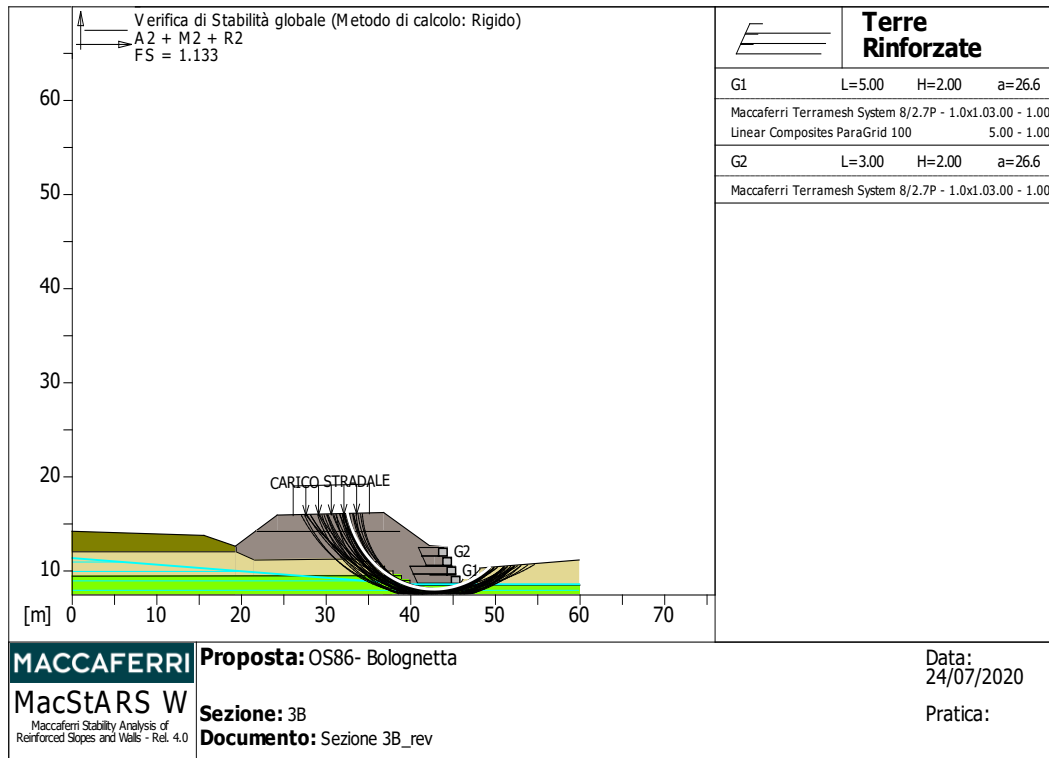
Verifiche stabilità globale muro terra-mesh – condizione statica.
